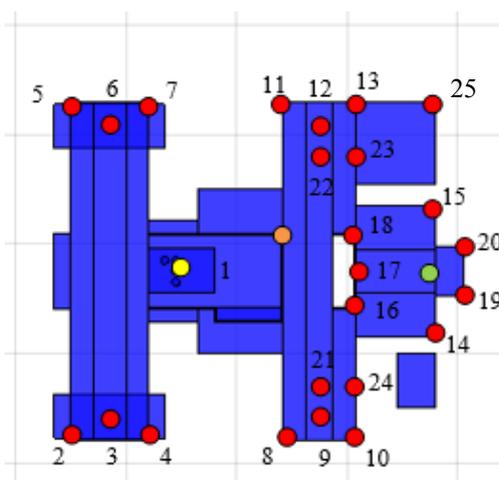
Vista en planta del edificio con la ubicación de los PR.
